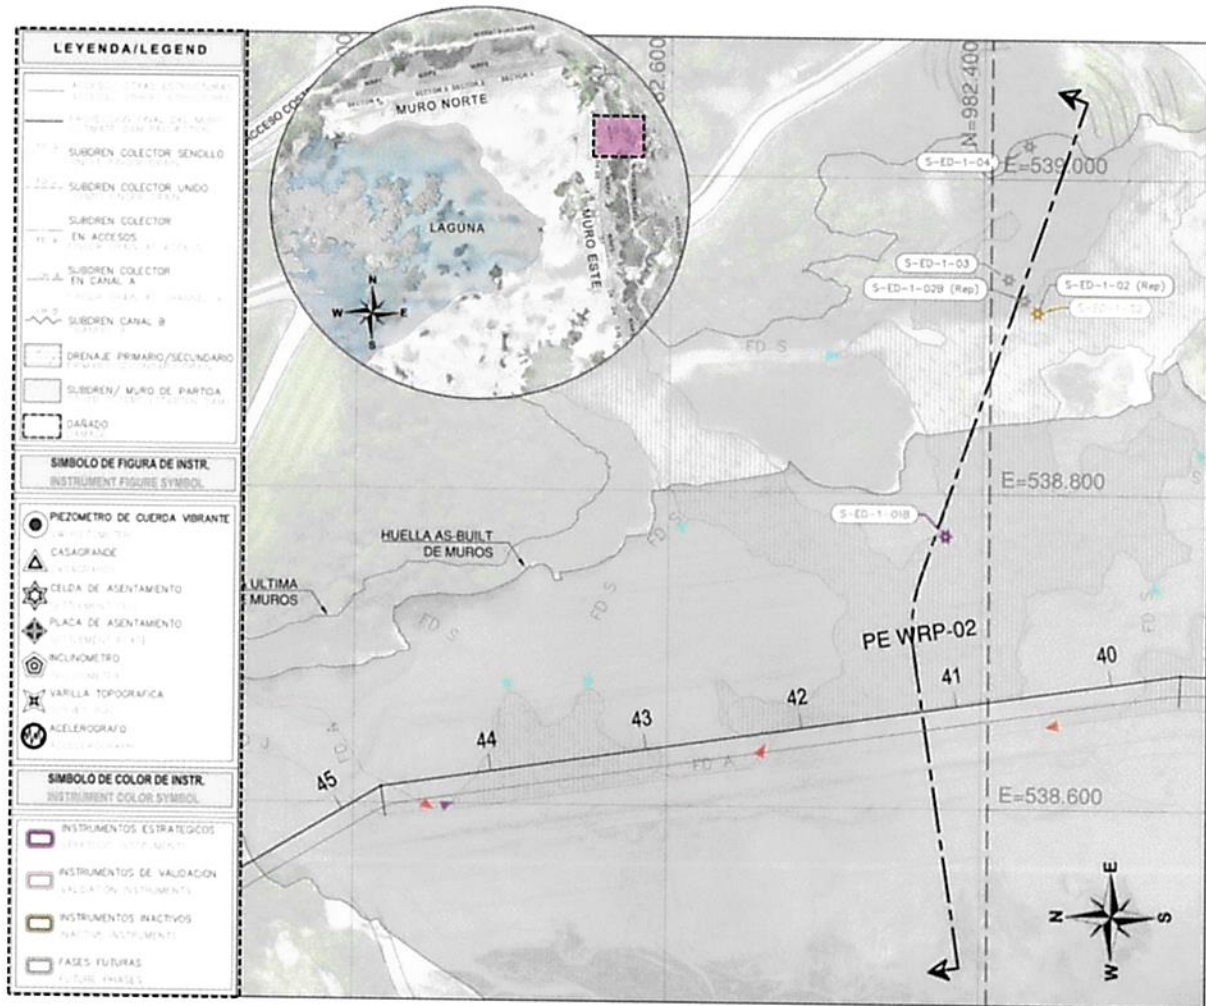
Vista de Planta en el Muro Este WRP1 con las Celdas de Asentamiento
